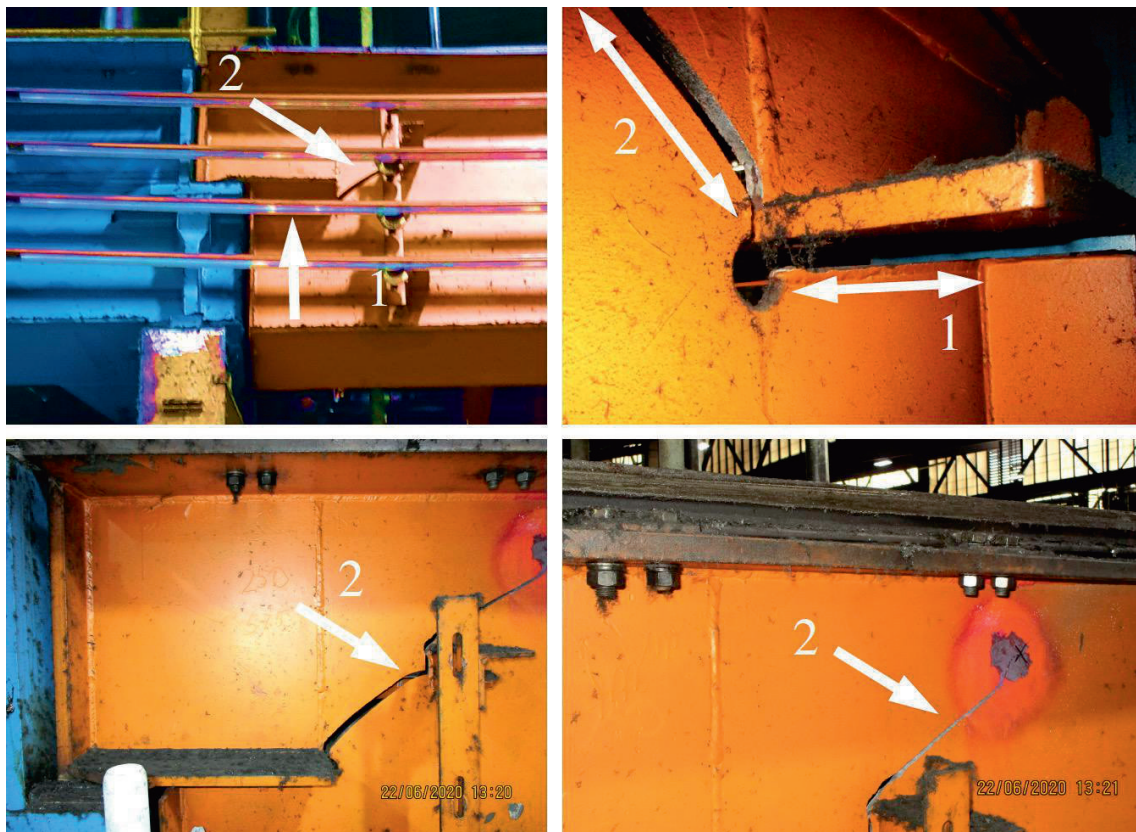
Ermüdungsrisse im Auflagerbereich einer Kranbahn S6, Baujahr 1967
